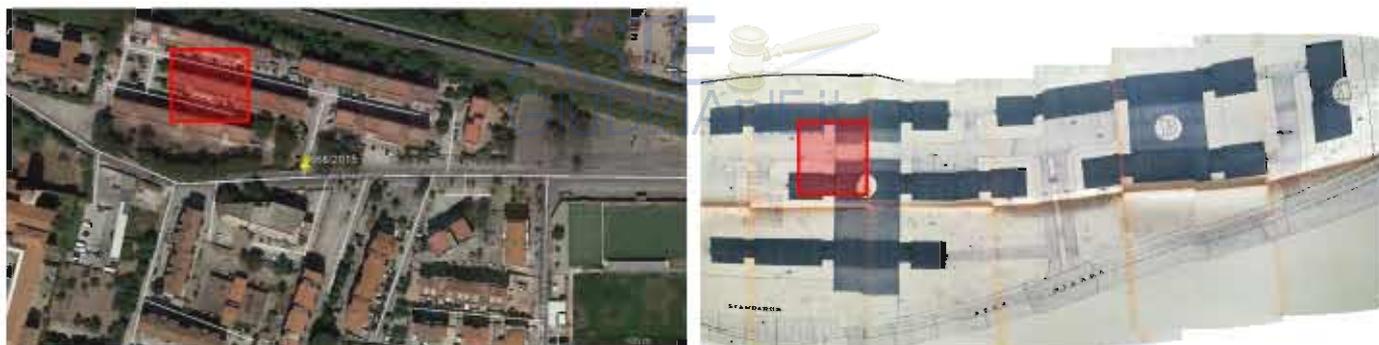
Individuazione dell'immobile sito in Aversa, nell'ortofoto e nella planimetria di progetto.
